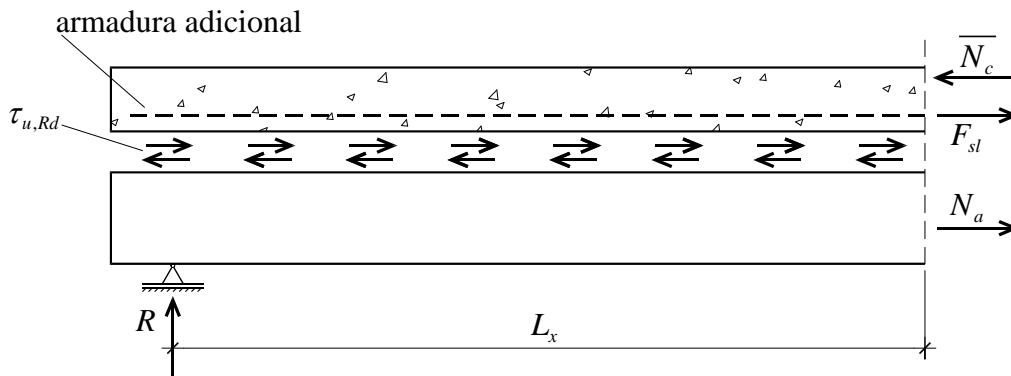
Forças atuantes num segmento de laje mista com armadura adicional.
